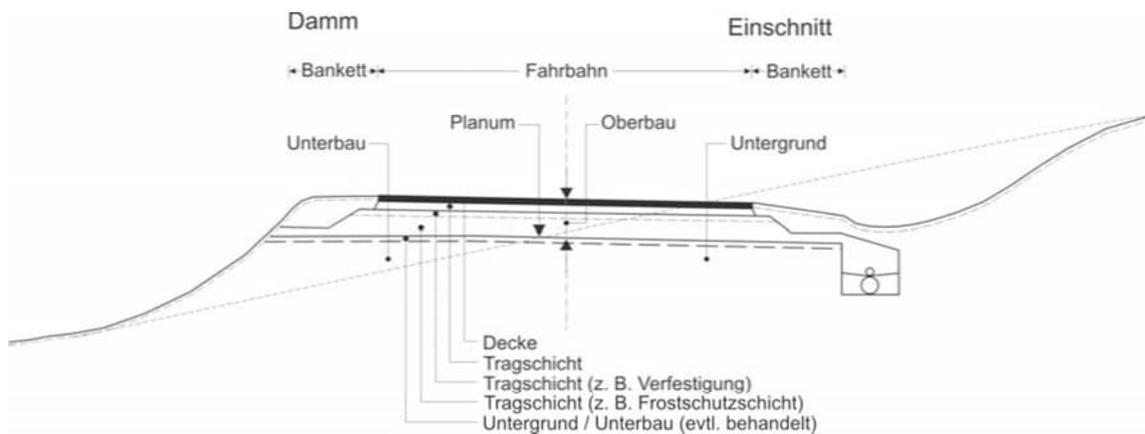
Beispielhafter Aufbau einer Befestigung außerhalb geschlossener Ortslage sowie in geschlossener Ortslage mit wasserdurchlässigen Randbereichen – Damm/Einschnitt –
